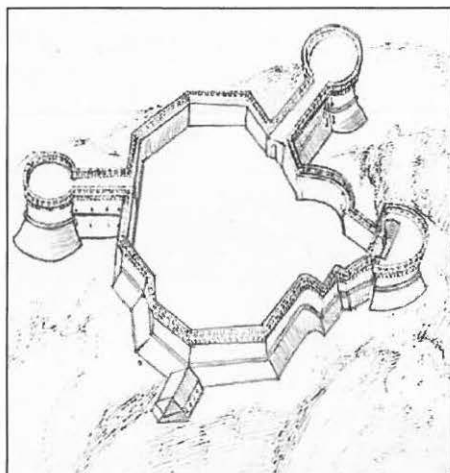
“Rocca di pianta irregolare con torrioni né luoghi più opportuni”.
